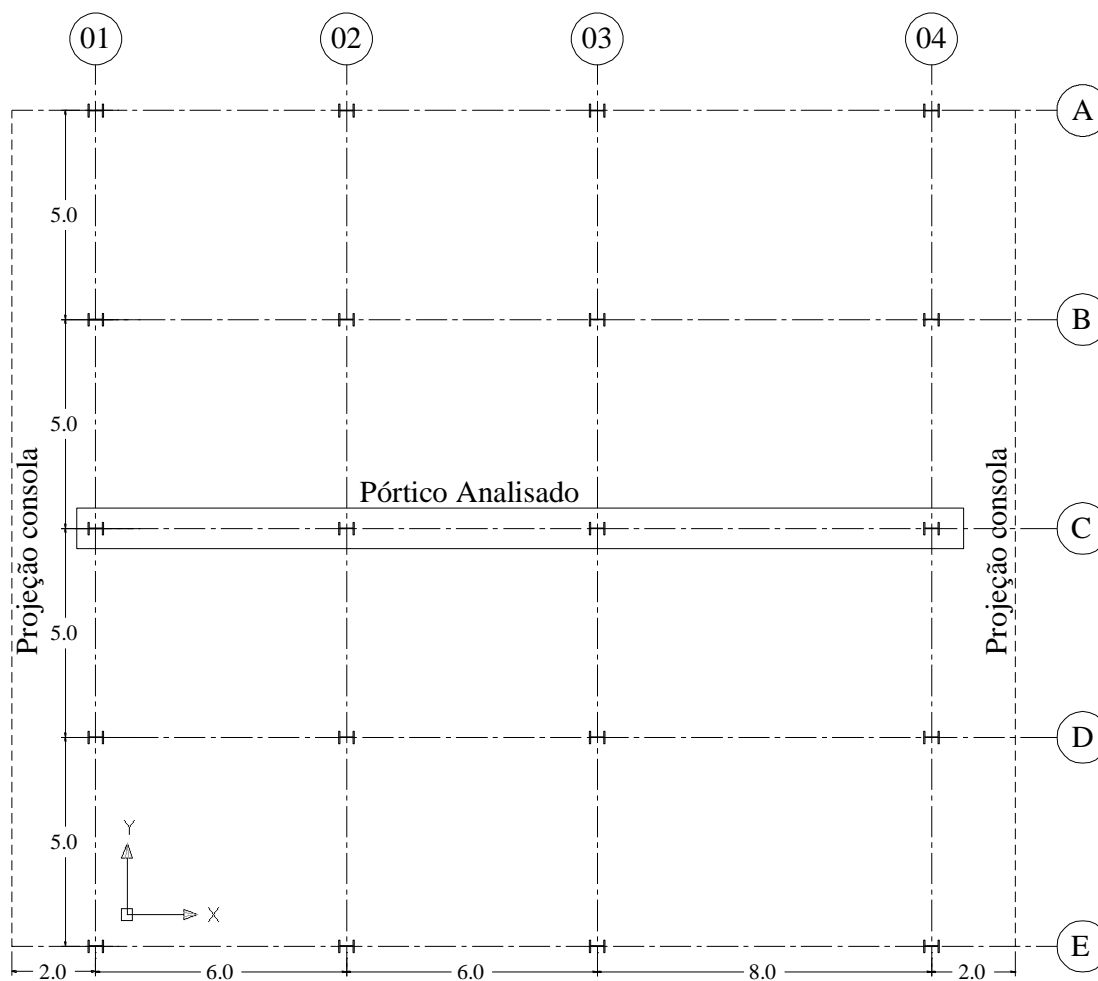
Planta de localização dos pórticos metálicos de múltiplos andares (dimensões em metro).
